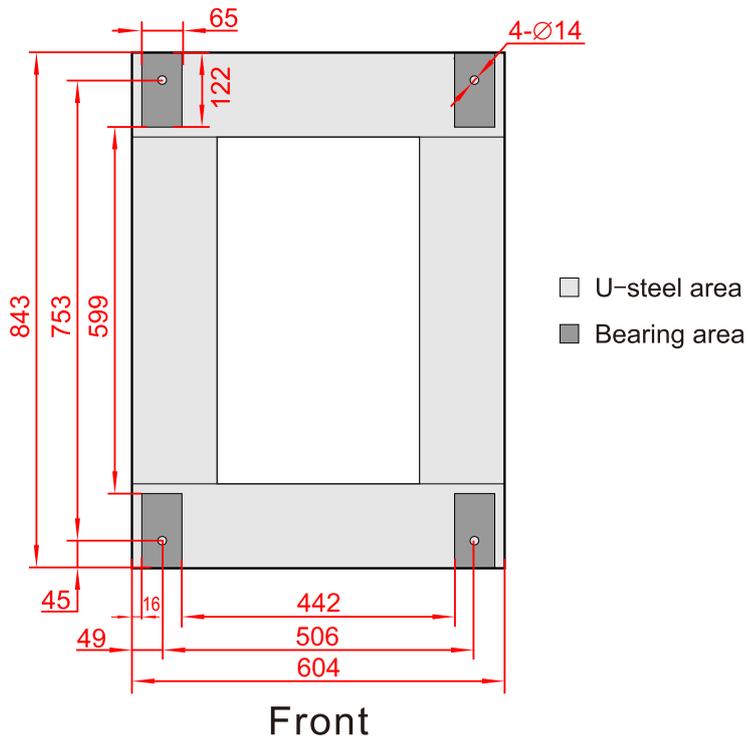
Рекомендуемые размеры швеллеров. U – steel area - швеллер, Bearing area – опорные площадки.
